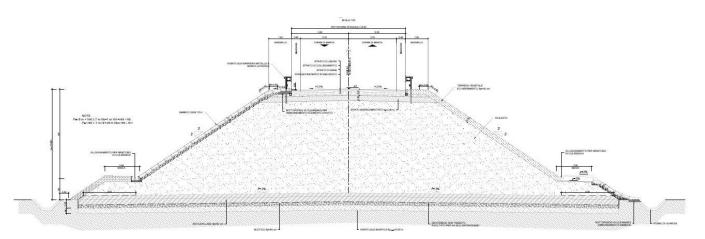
Dest. Particolare 6.5m - sezione tipo in rilevato $Hril \geq 6.00 m$
